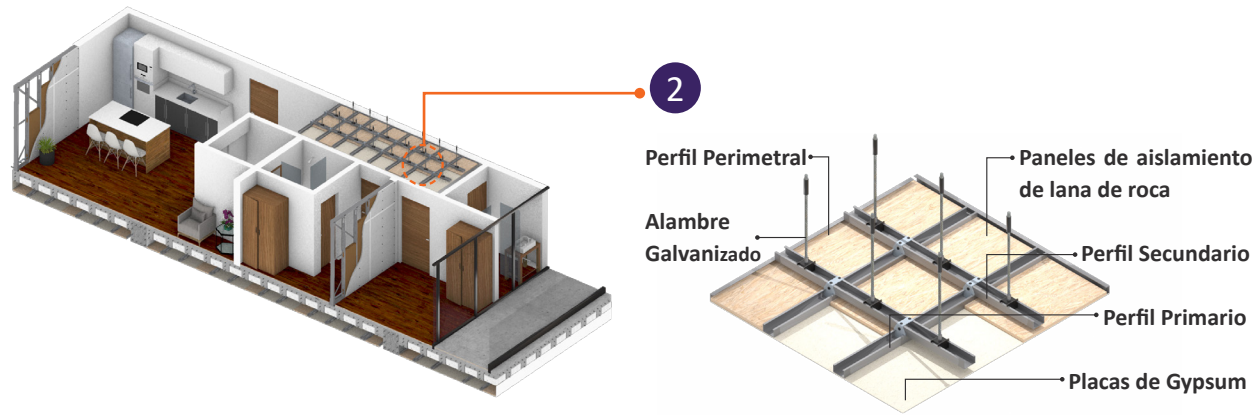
Detalle constructivo de techo con aislamiento de fibra mineral.
